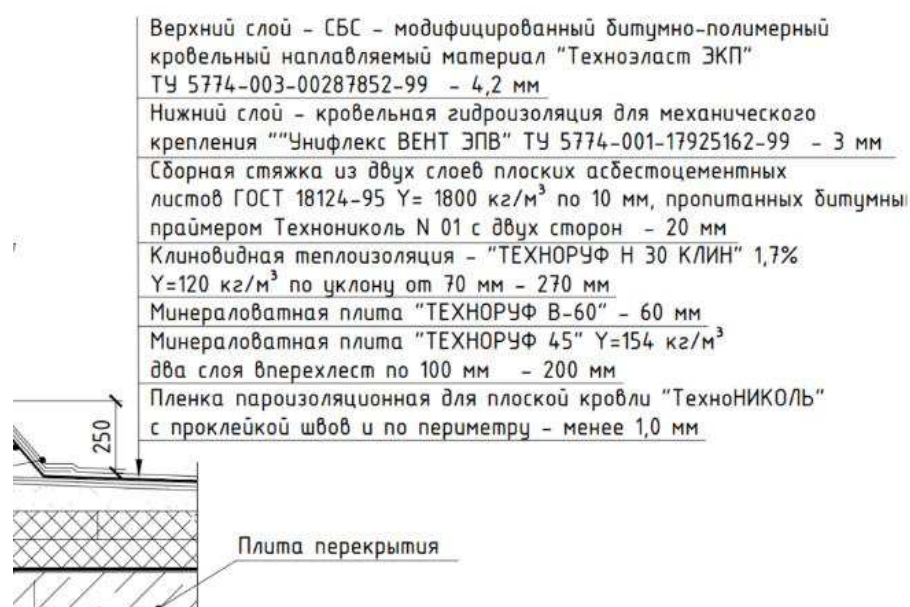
Схема расположения слоев системы теплоизоляции ограждающей конструкции кровли
